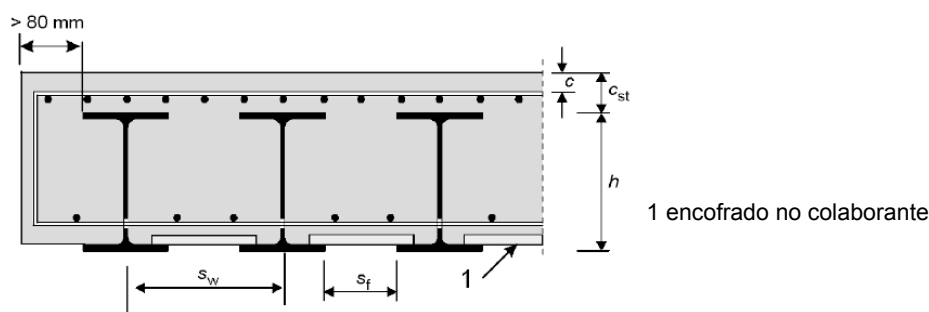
Sección transversal típica de un tablero con vigas de acero embebidas
